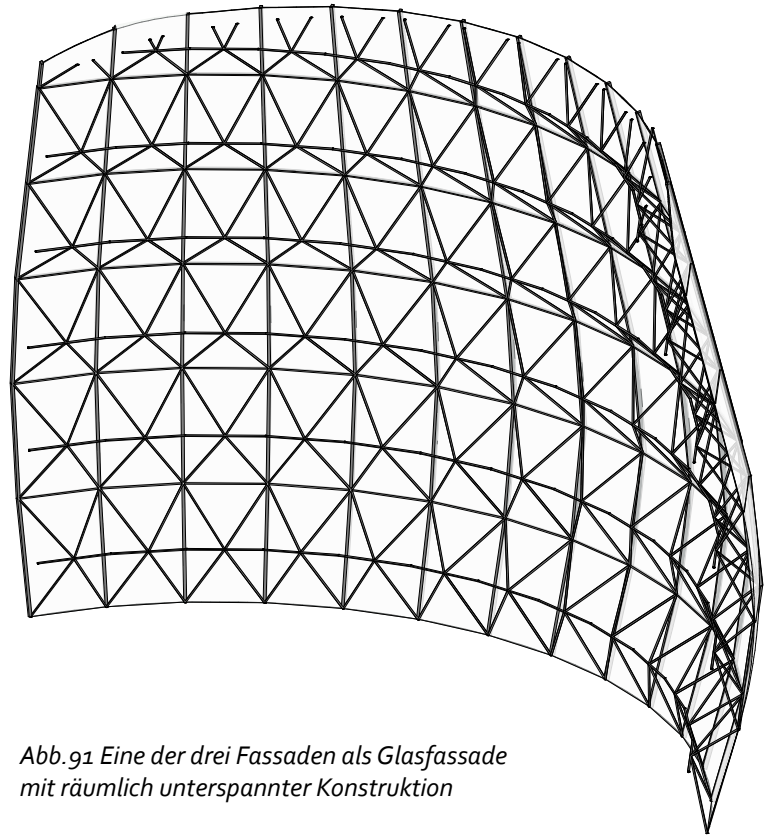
Eine der drei Fassaden als Glasfassade mit räumlich unterspannter Konstruktion
